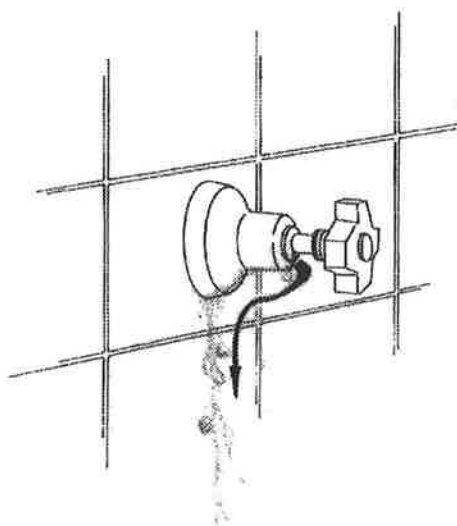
Vazamento conduzido pela haste em registros de gaveta ou de pressão.
